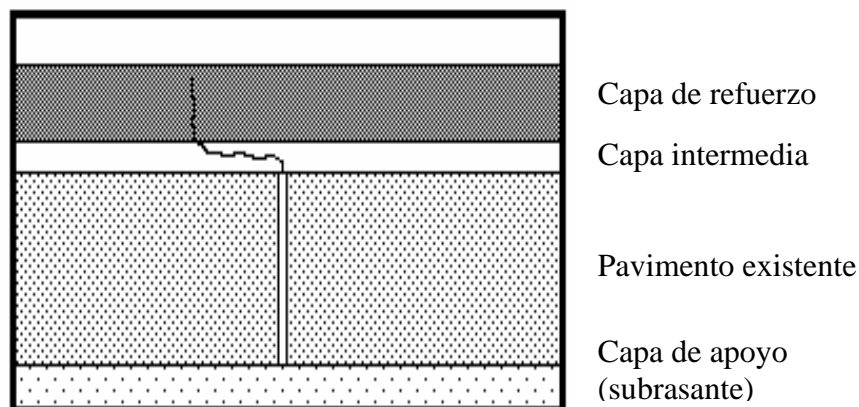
Re direccionamiento de la fisura y atraso de la reflexión
